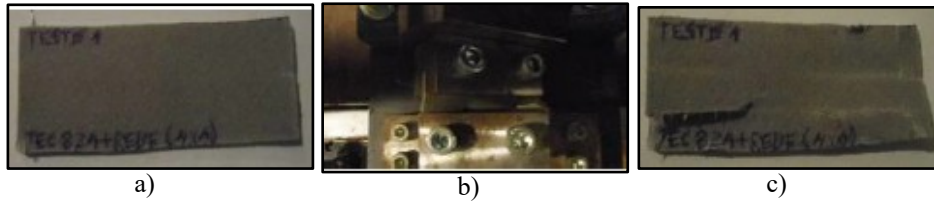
Torção tela Cimentícia c/ rede e pré-corte: a) antes do ensaio, b) em ensaio, c) após o ensaio
